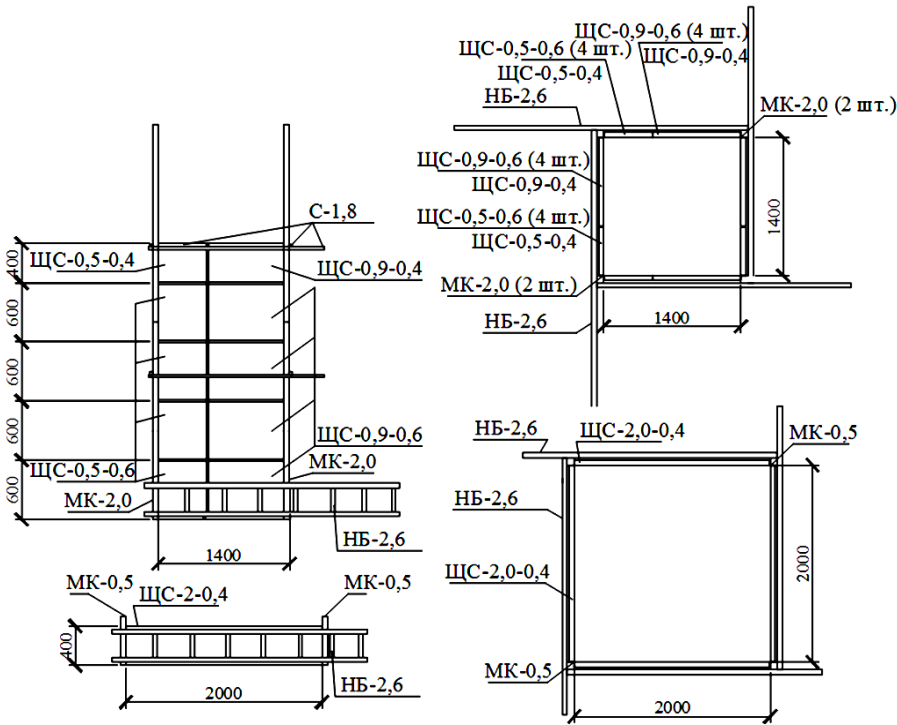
Маркувальна схема опалубки ступінчастого фундаменту.
